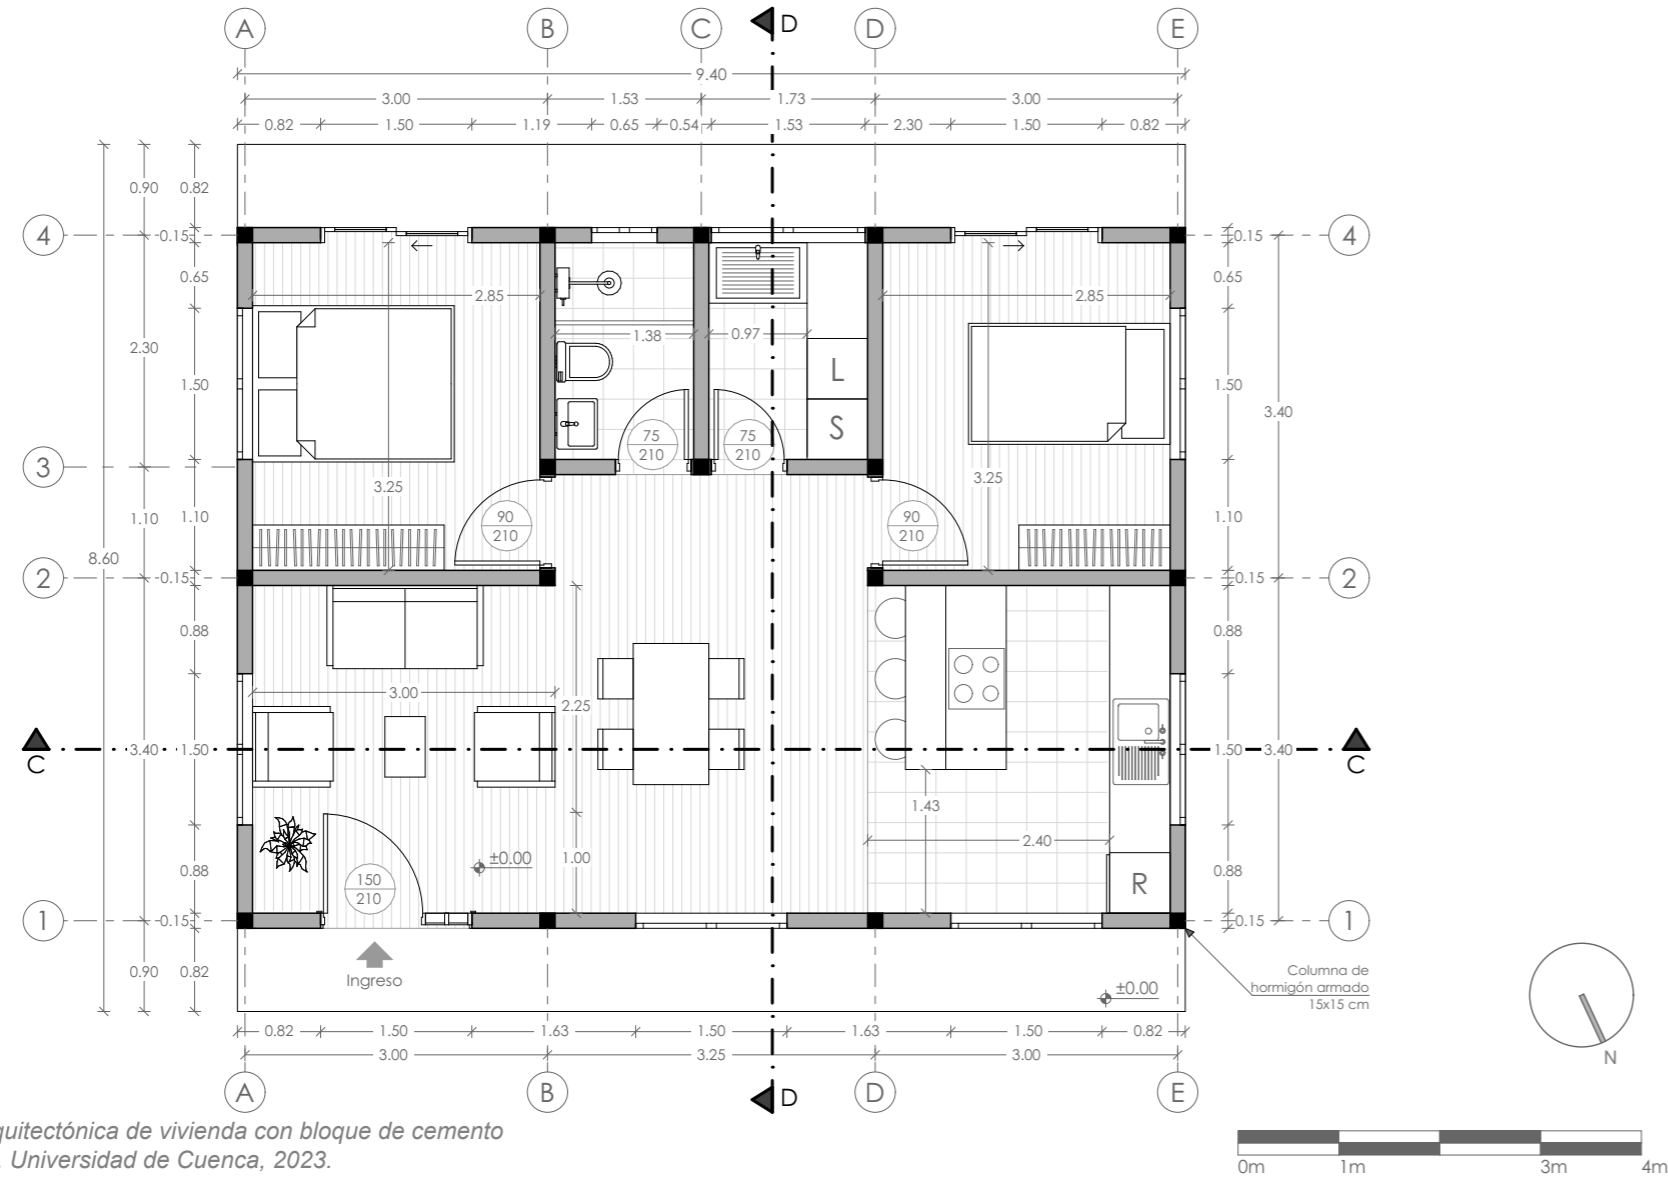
Planta arquitectónica de vivienda con bloque de cemento
